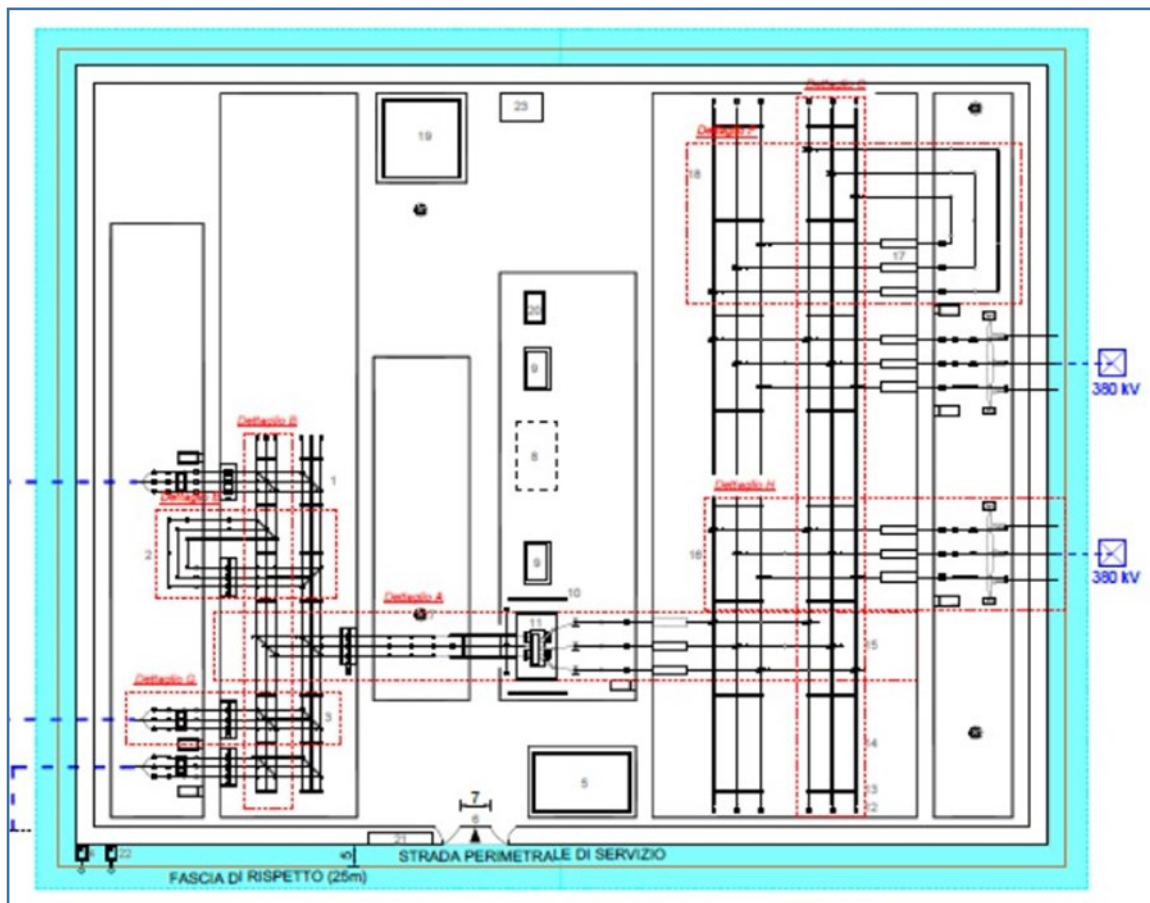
PIANTA STAZIONE ELETTRICA RTN TERNA 380/132 Kv
